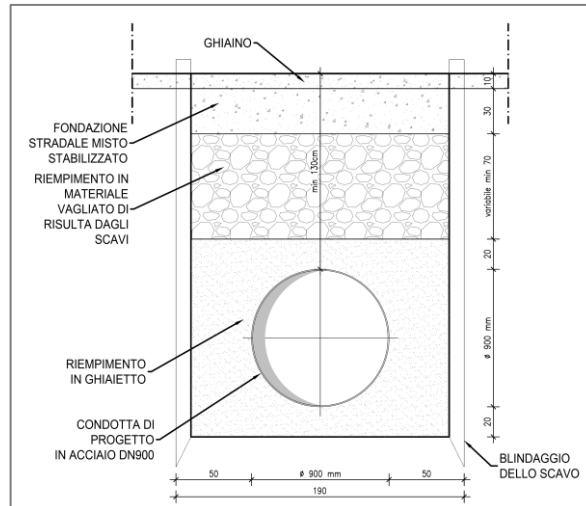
Sezione tipo di posa su strada sterrata - stralcio 1.
